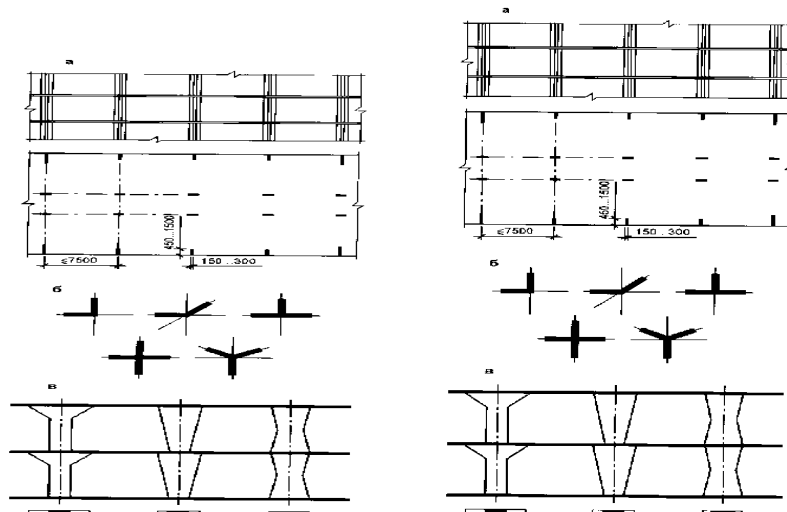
Монолитный безригельный каркас с колоннами в виде коротких стенок-диафрагм: а - фрагменты фасада и плана каркаса здания коридорного типа; б - возможные формы сечений колонн; в - формы колонн переменного сечения по высот
